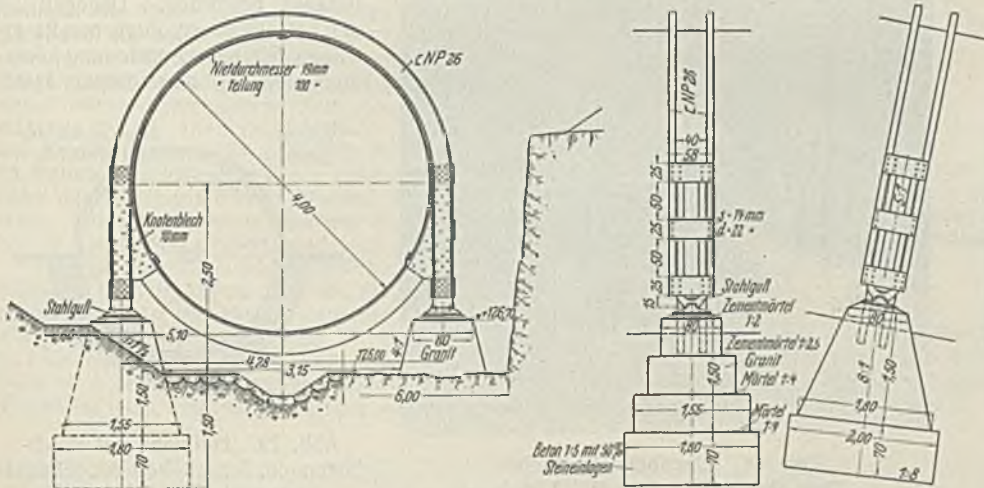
Weitspanrohrleitung für das Kraftwerk Haby (Schweden) (Vattenbyggnadsbyran, Stockholm).
